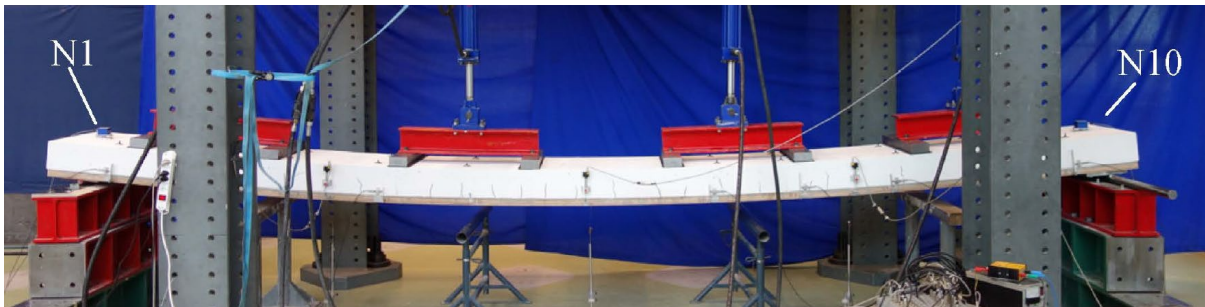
Biegeversuch mit einem Holz-Beton-Verbunddeckenelement aus Buchenholz
